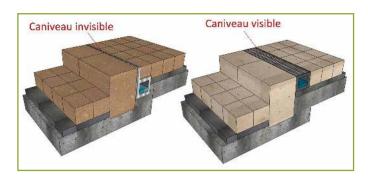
Schéma de deux types de caniveaux dans un escalier (Dessin de Cédric Houel)
